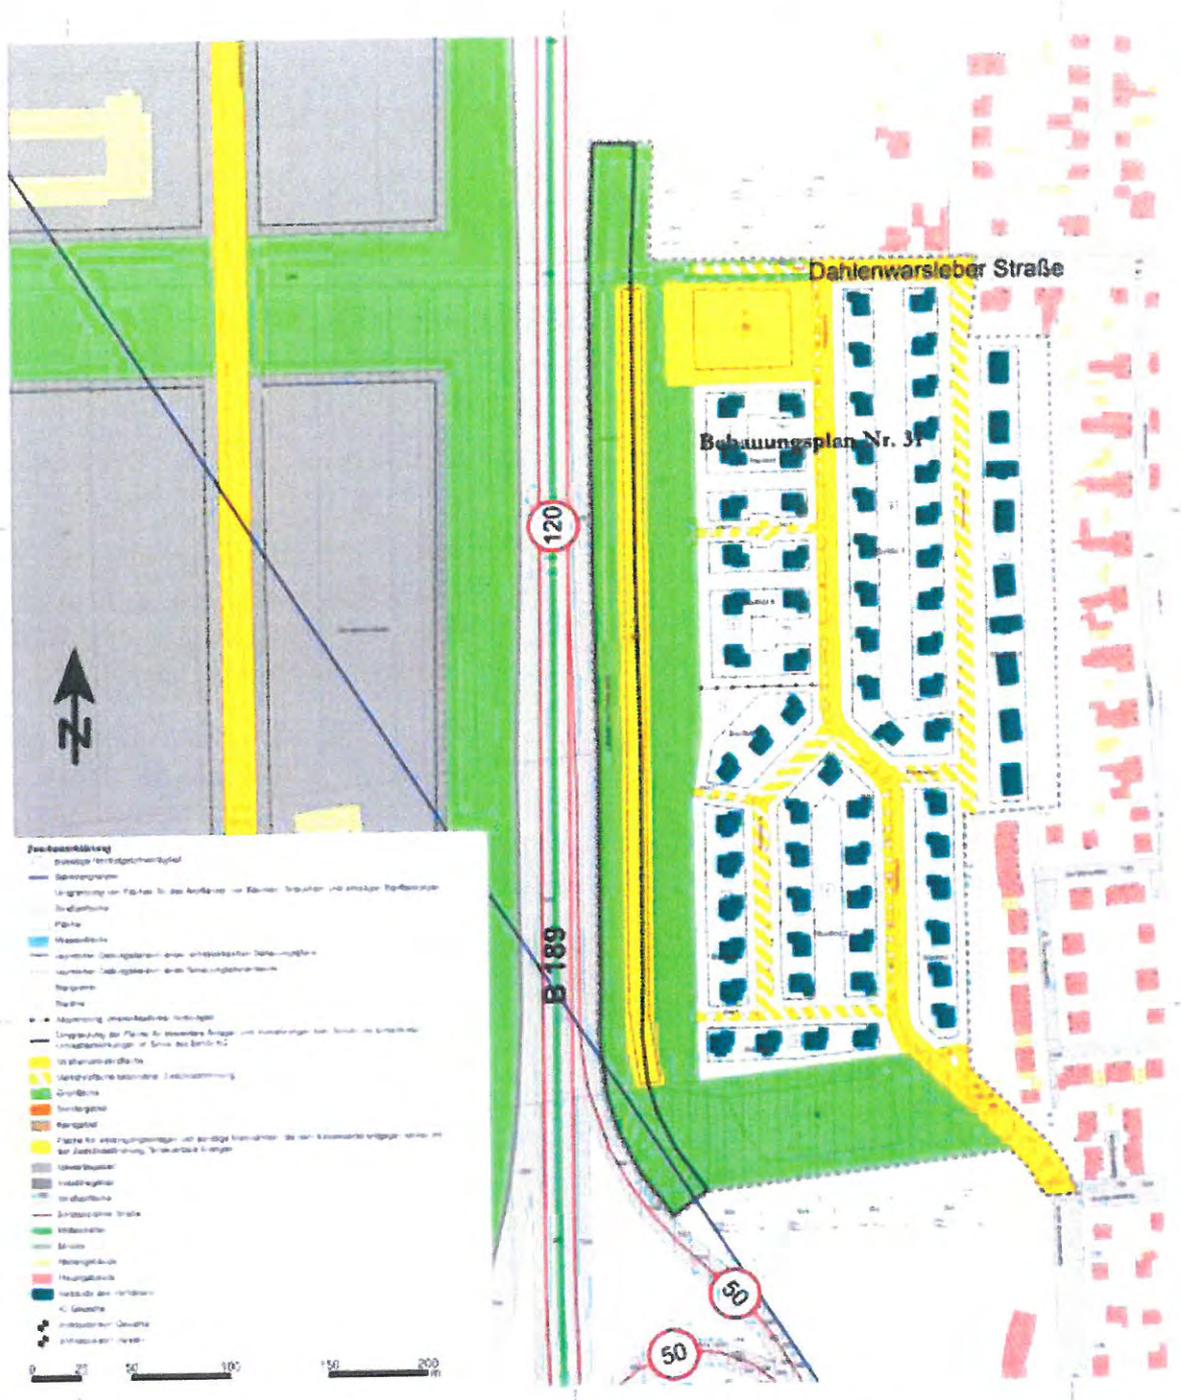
Lageplan des Berechnungsmodells mit bestehender Bebauung und geplanter Bebauung (Gebäude in Petrol) gemäß Gestaltungsplan /30/ zum Bebauungsplan Nr. 31 /29/ und planungsrechtliche Situation von angrenzenden Bereichen
